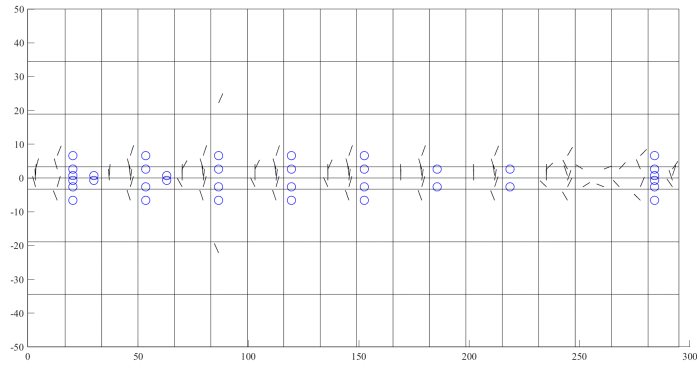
Padrão de fissuração na camada inferior da laje de concreto (viga B1NB1/uni), (passo 18)
